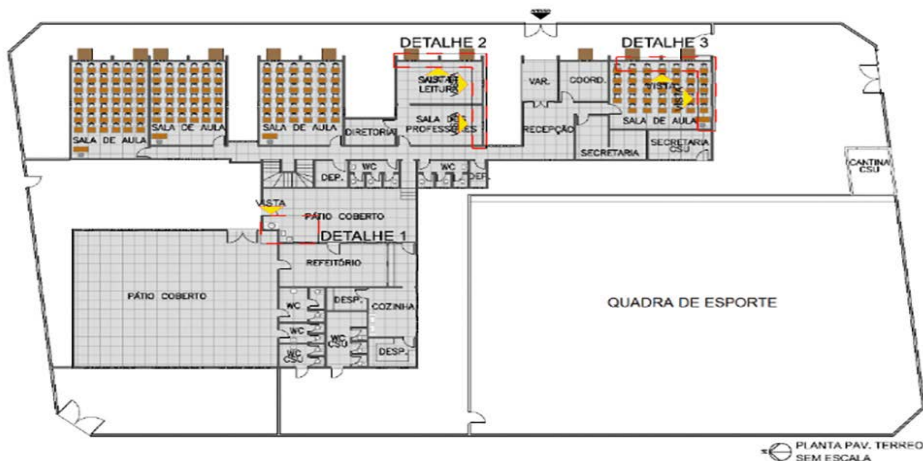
Planta Baixa das intervenções arquitetônicas na escola B.
